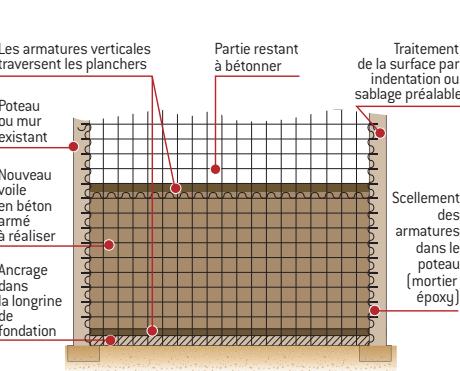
Exemple de renforcement du contreventement d'un bâtiment par création de murs nouveaux entre deux poteaux existants [élevation]
